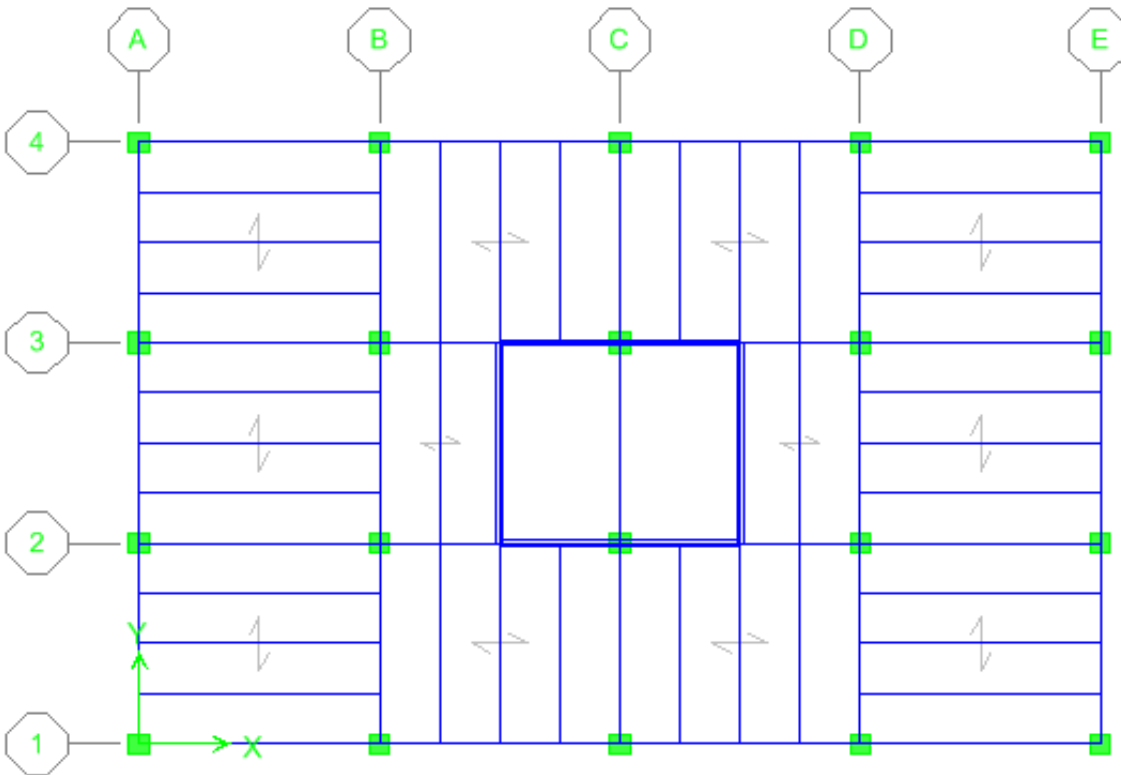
Planta estructural de entresijos para el análisis y diseño estructural del edificio diseñado, proveniente de eTabs
